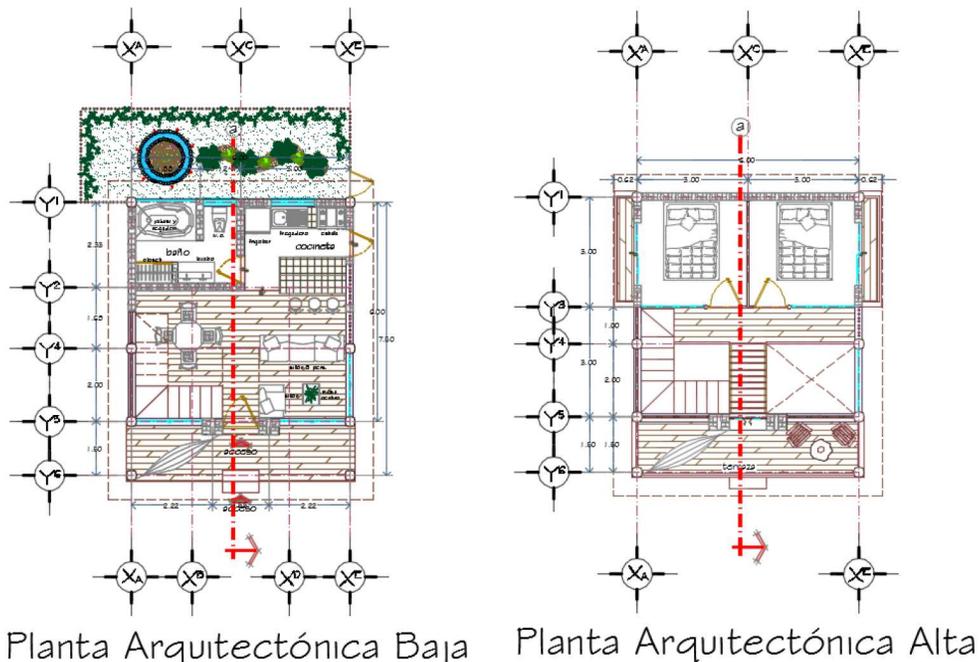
Vista de planta de conjunto de la Cabaña Tipo Familiar del proyecto.
